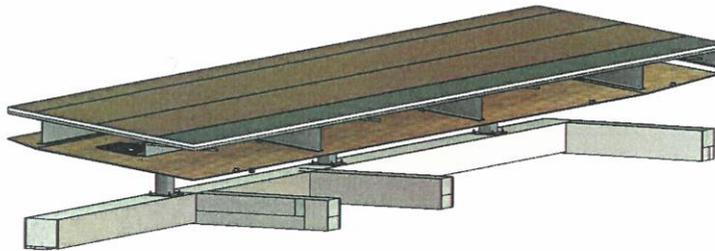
DETALLES DE LAS ESTRUCTURAS METALICAS
